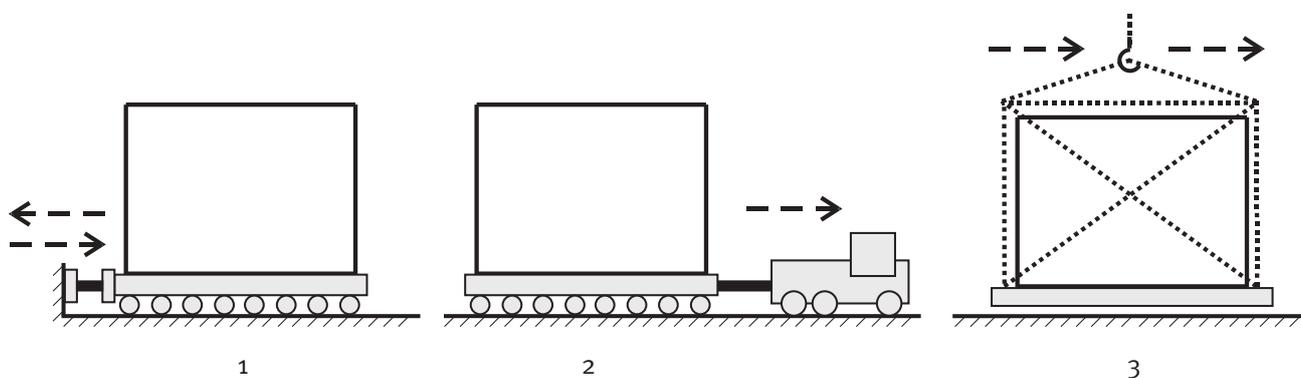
Перемещение здания: 1 – с балочными клетками с помощью гидродомкратов или лебедок; 2 – на колесных платформах с железнодорожной или автомобильной тягой; 3 – с пространственным временным каркасом – кранами и вертолетами
